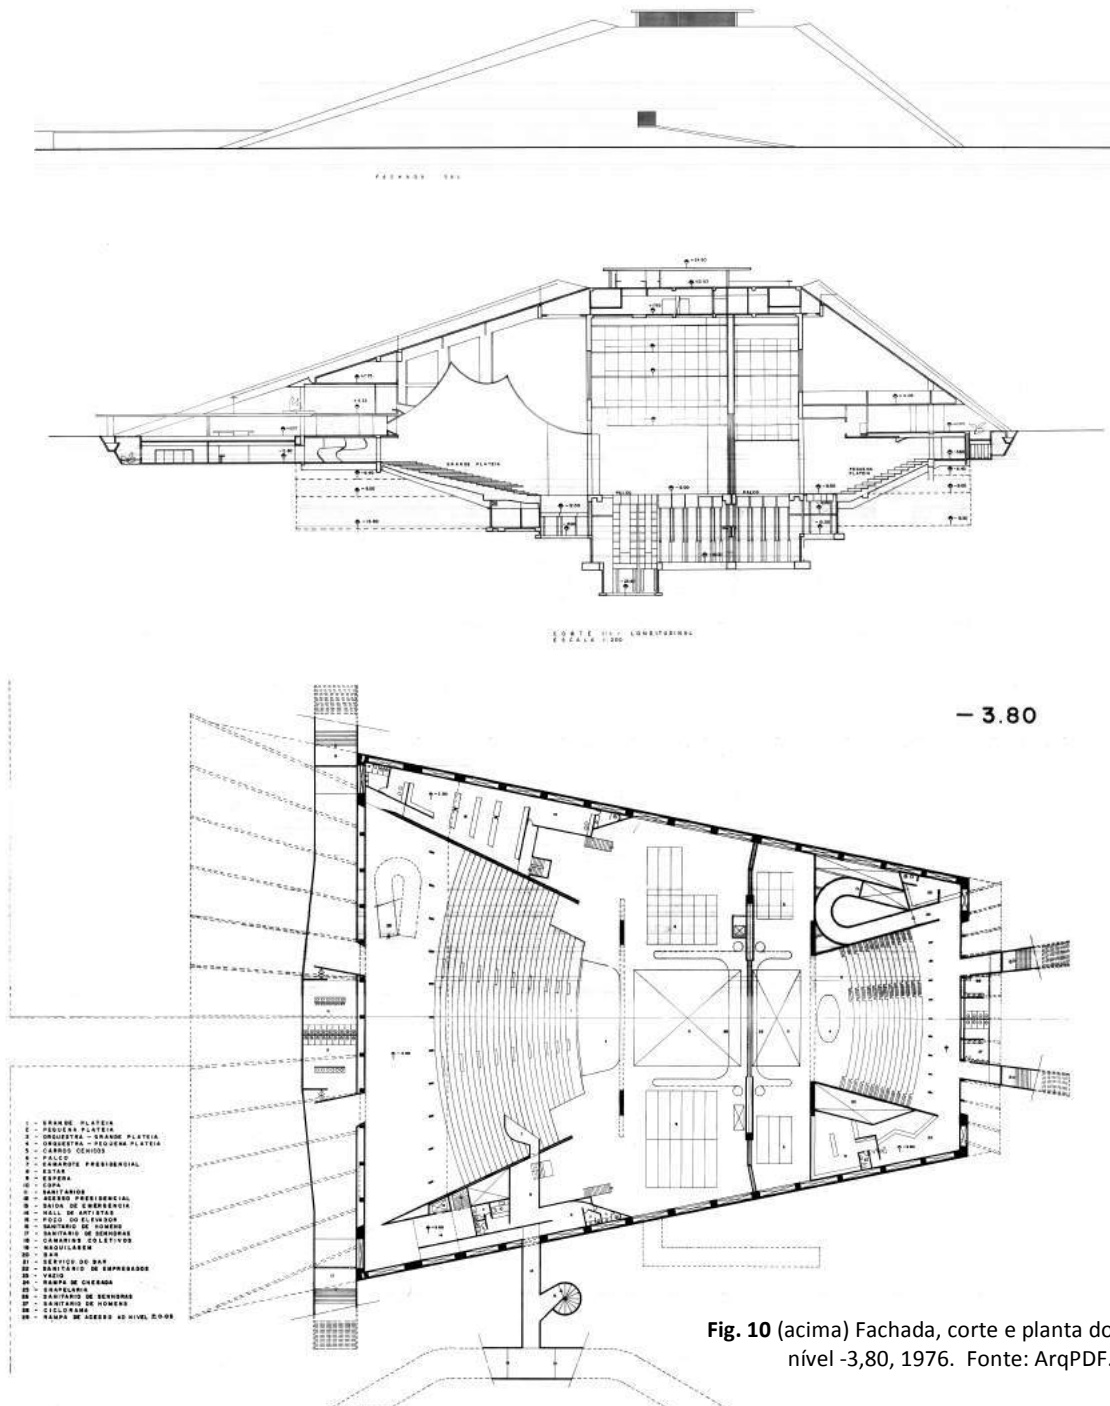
(acima) Fachada, corte e planta do nível -3,80, 1976. Fonte: ArqPDF.
